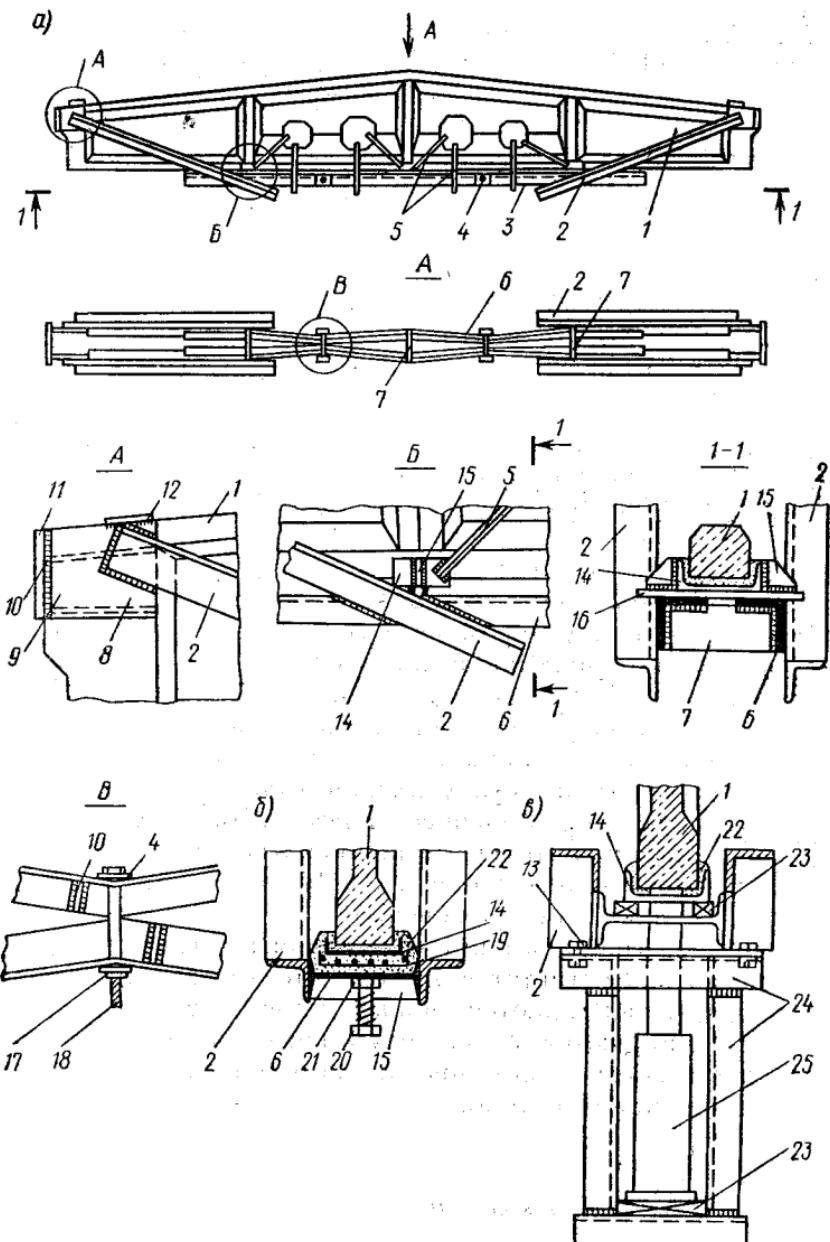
Усиление стропильной балки предварительно напряженным шпренгелем из уголков:
